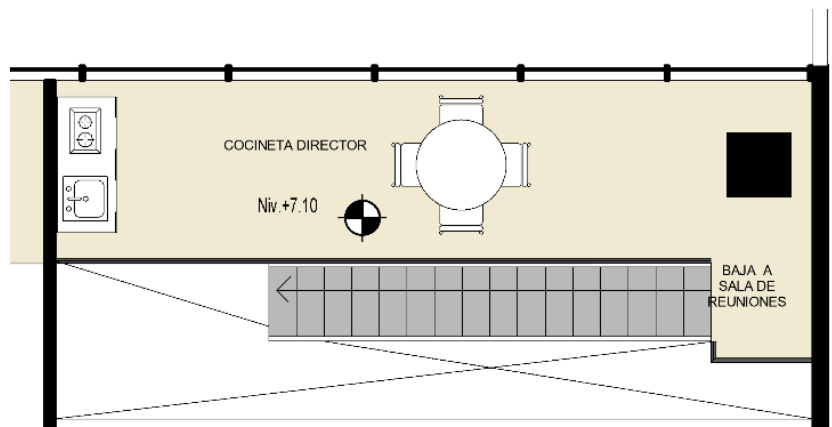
Planta Nivel 1. Fuente: Elaboración propia.
